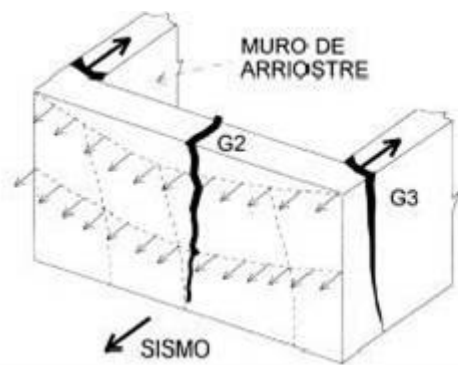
Fallas típicas en construcciones de adobe por acción sísmica perpendicular al plano de los muros: desgarramiento vertical en las esquinas y grieta vertical por flexión en la zona central del
